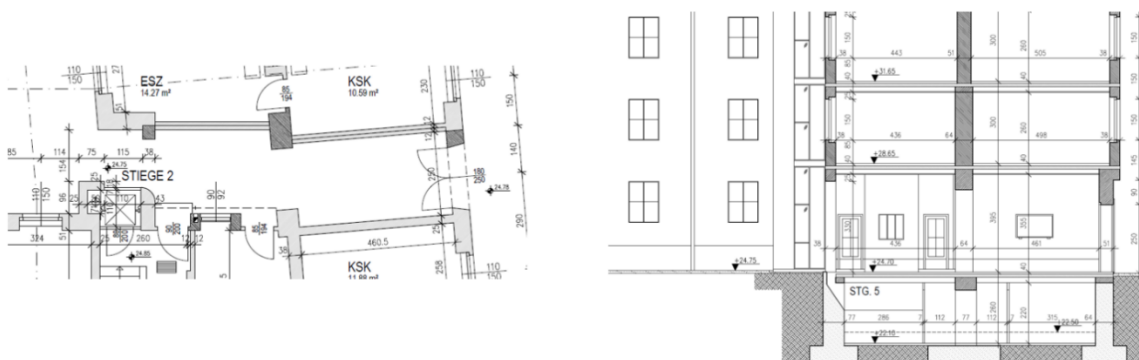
Grundriss des westlichen Durchganges (links) und Aufriss durch den östlichen Durchgang (rechts, eigene Darstellung).
